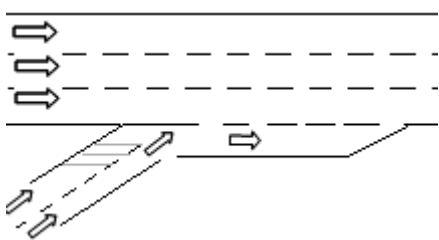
MÚK Roztyly [Zdroj autor DP]
